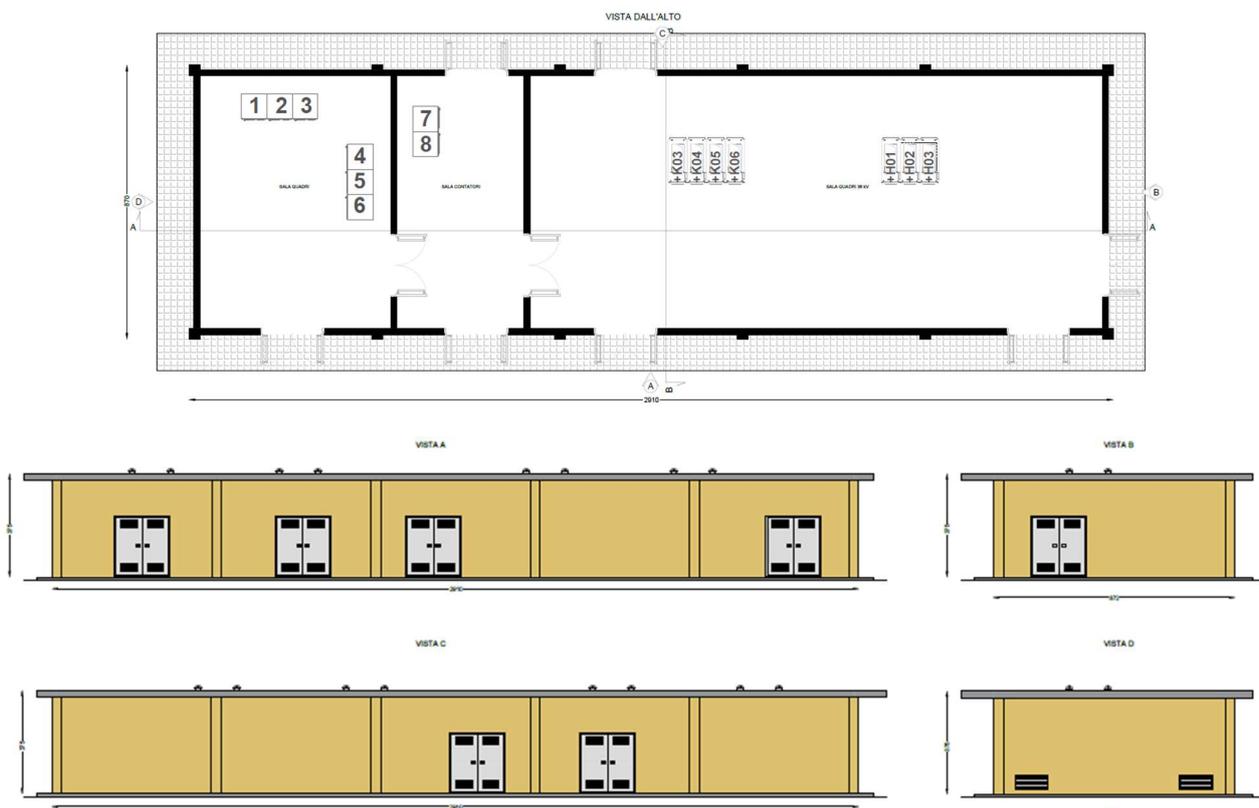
Planimetria e prospetti della cabina di trasformazione
